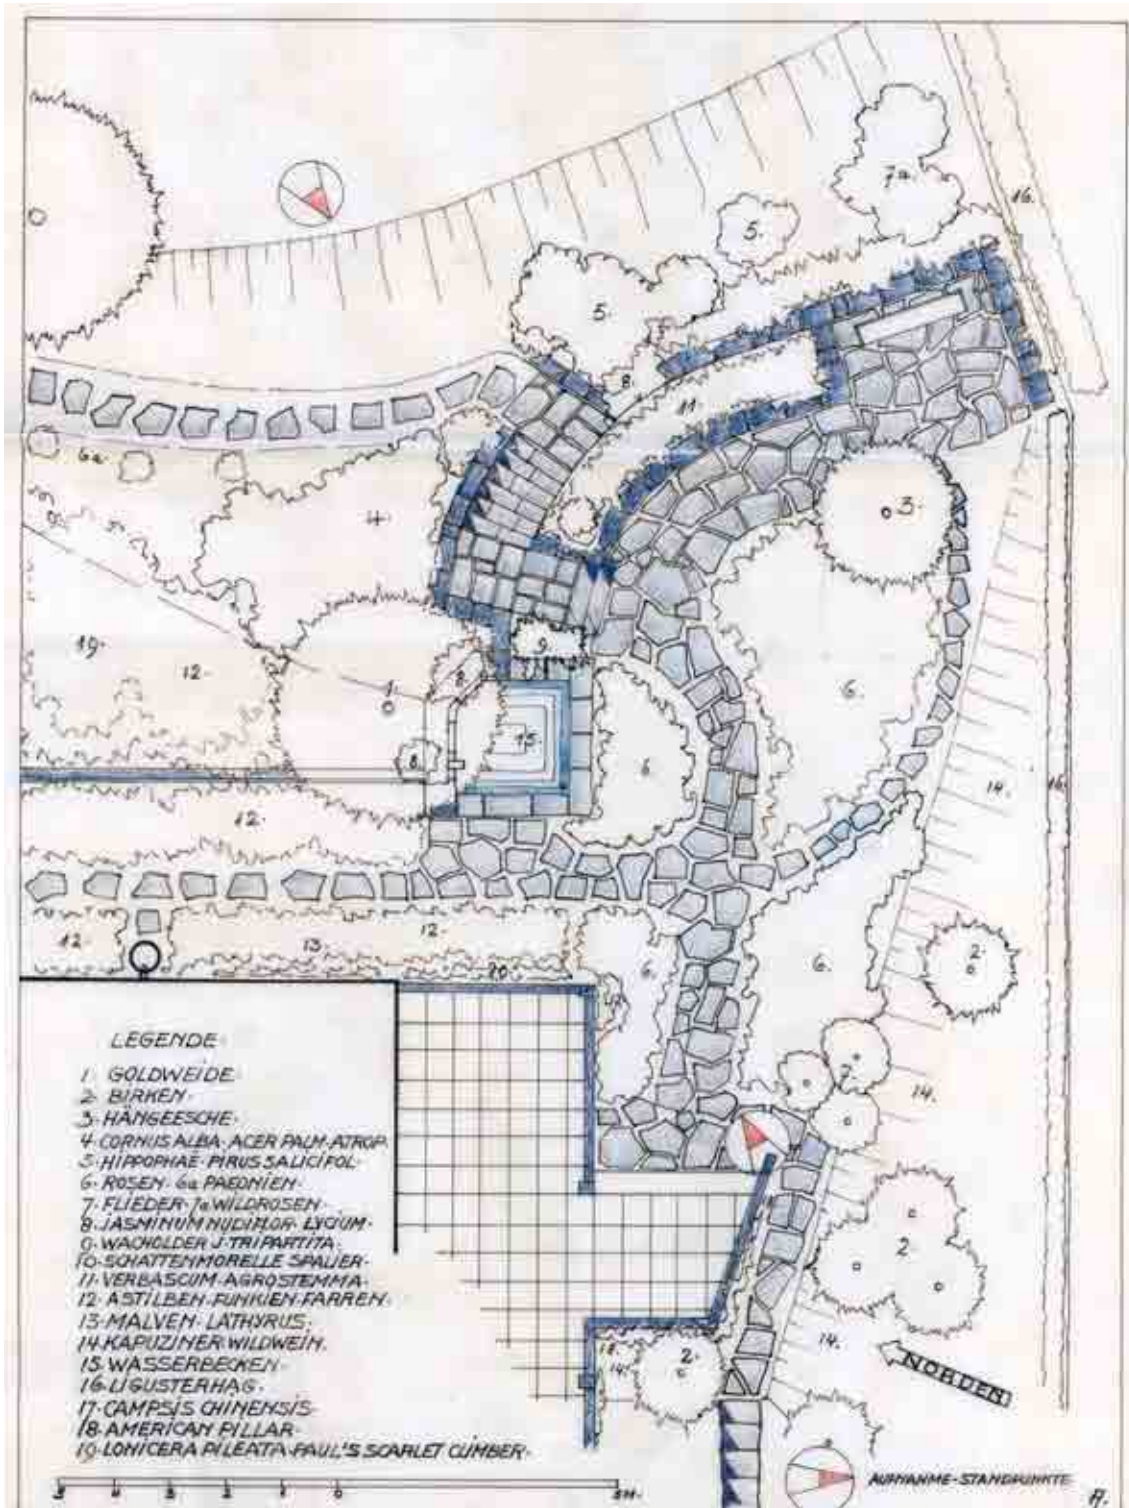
Grundriss und Bepflanzungsplan des Garten Walthers von 1930.
